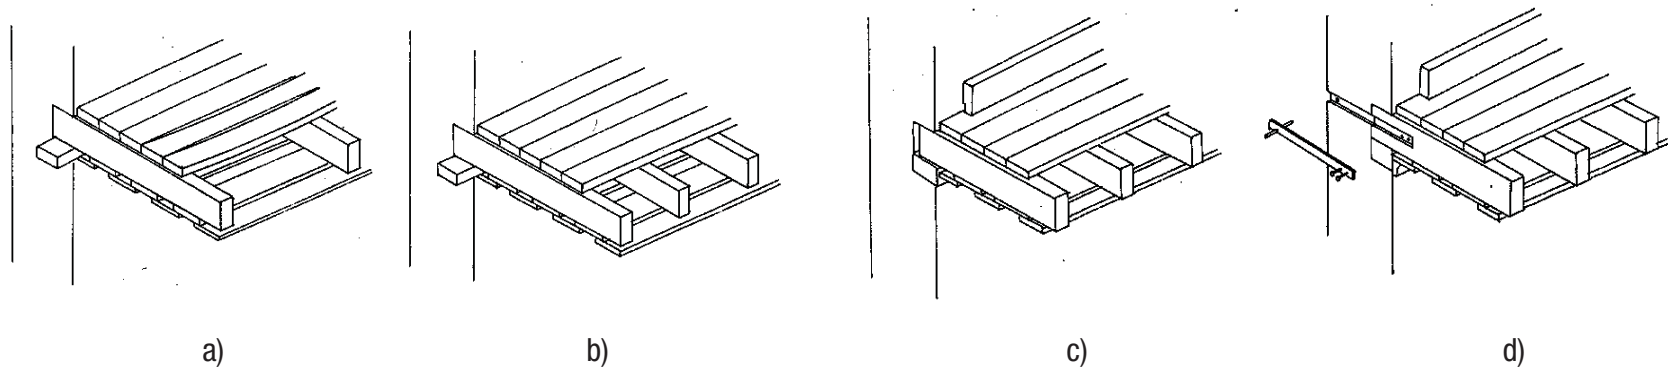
a), b) adição de novas vigas paralelas às vigas do pavimento; c), d) ancoragem da viga de madeira à parede de alvenaria.
